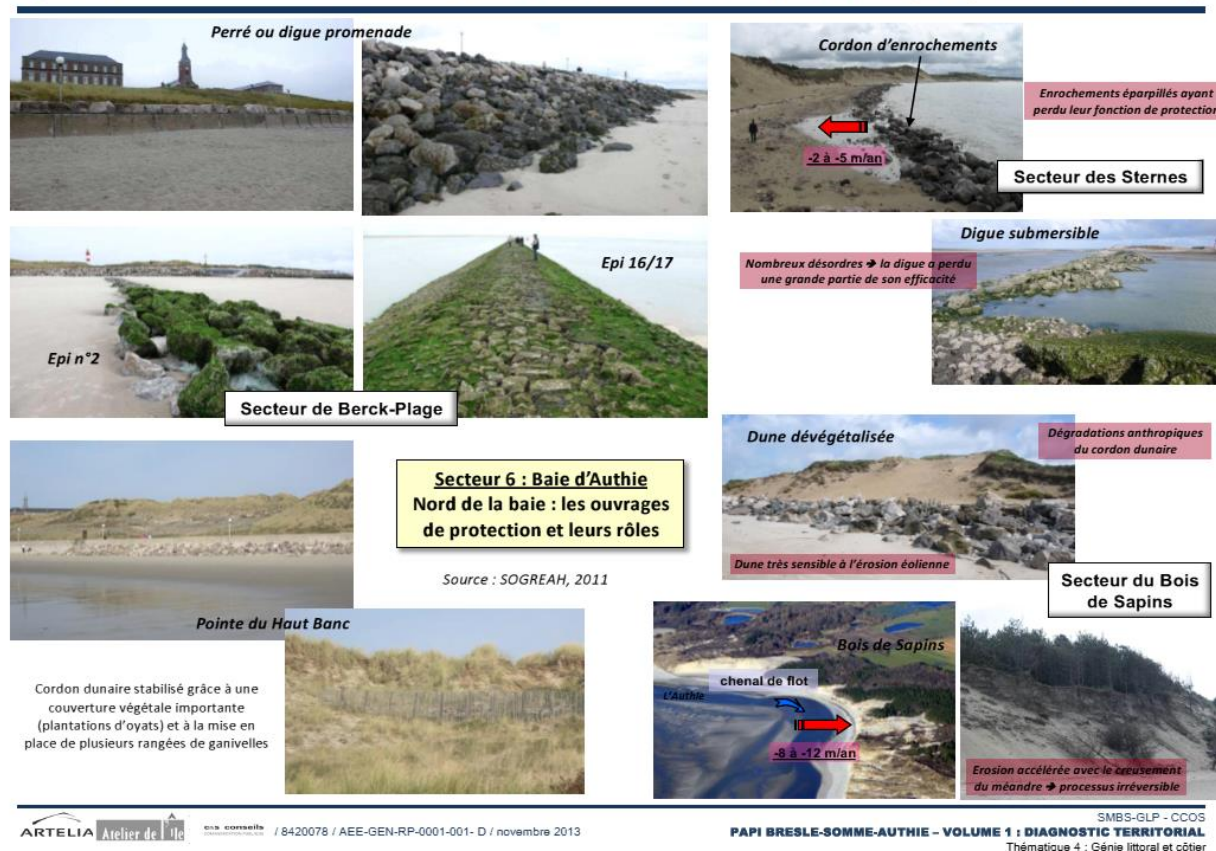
Ouvrages de protection sur la baie d'Authie Nord
